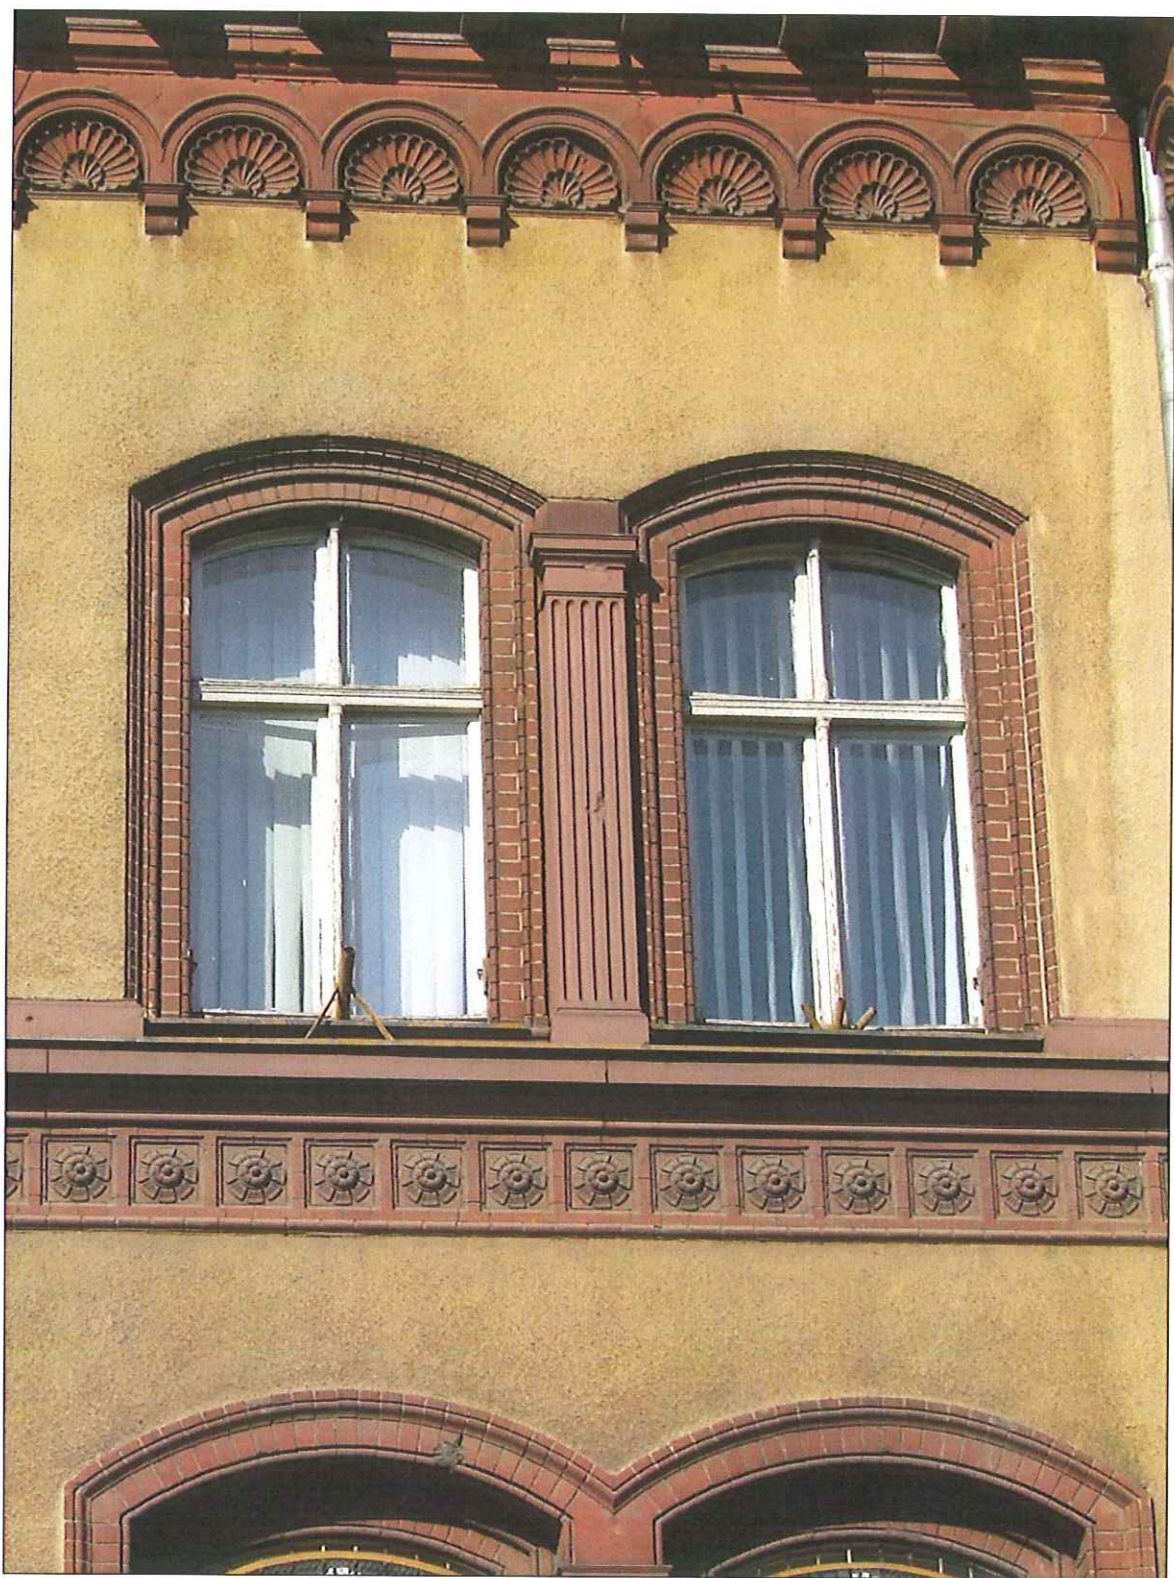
Elewacja zachodnia – przykładowa lokalizacja typów okien
